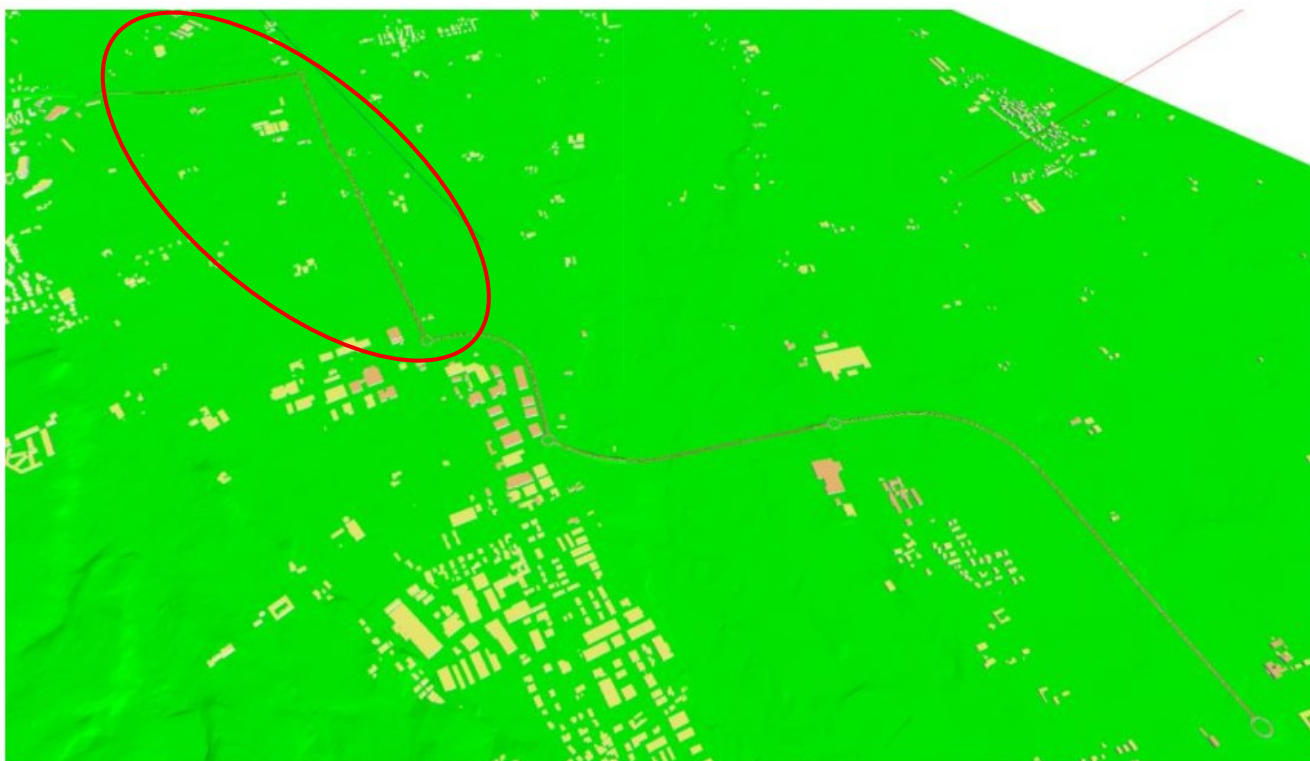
Modello dello stato di progetto (l'ovale individua nel dettaglio i lotti 2 e 3).
